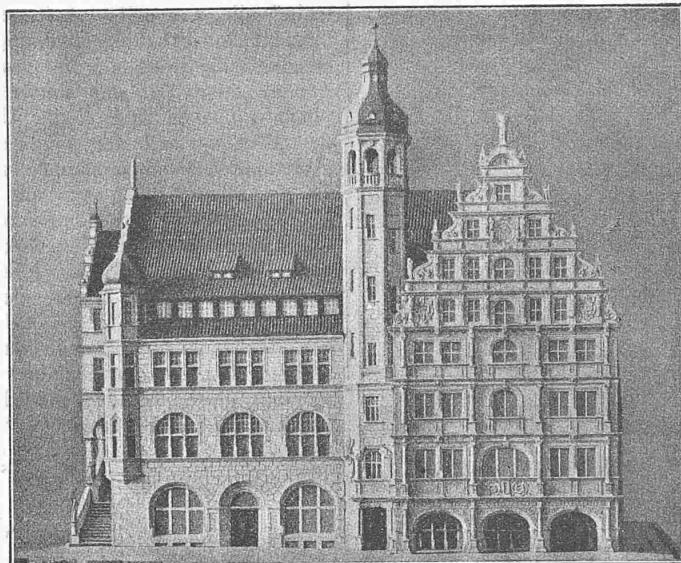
Modell des Braunschweiger Gewandhauses mit dem ursprünglich projektierten Anbau.
